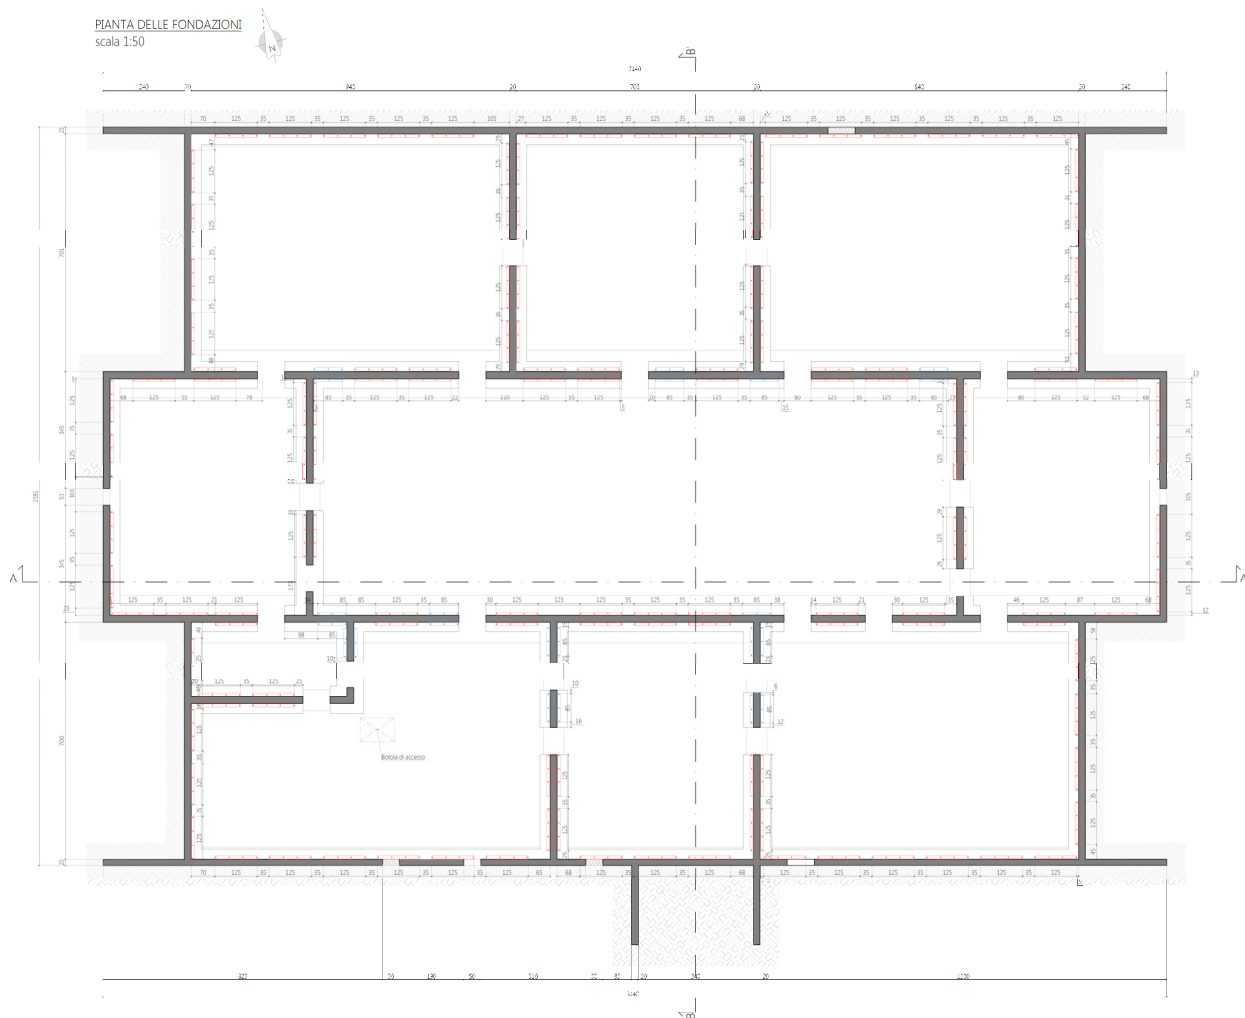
schema tipologico della disposizione degli elementi di rinforzo in fondazione
